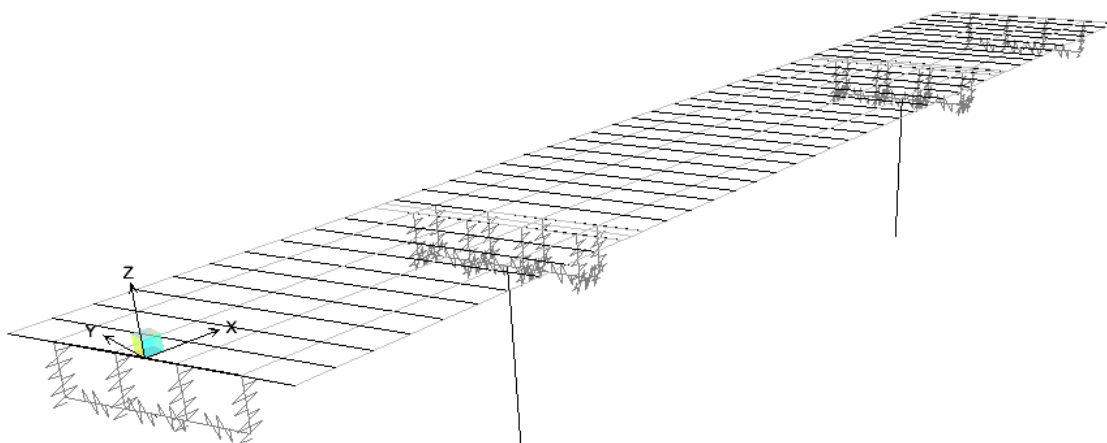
Modello di calcolo: con elementi shell soletta non in vista
